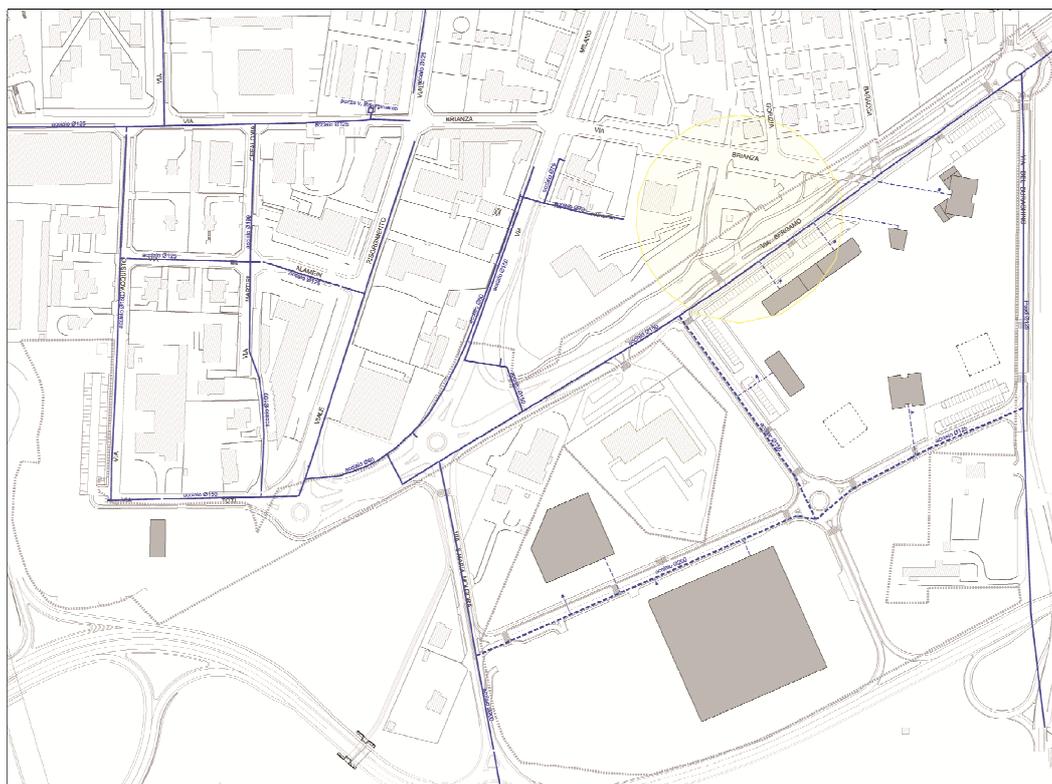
Planimetria generale della rete acquedottistica in progetto
